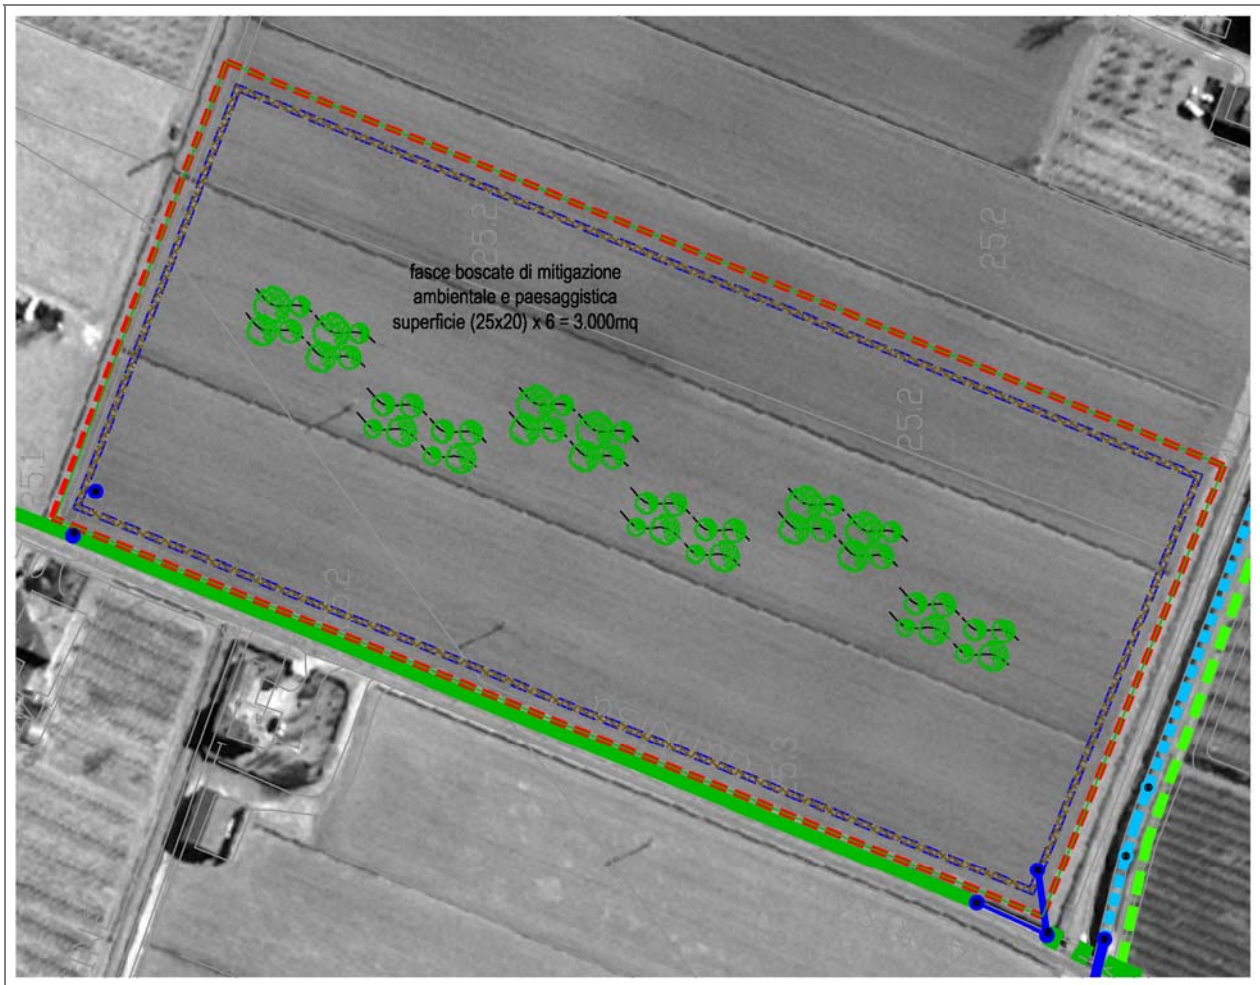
Disposizione planimetrica delle isole di vegetazione igrofila
